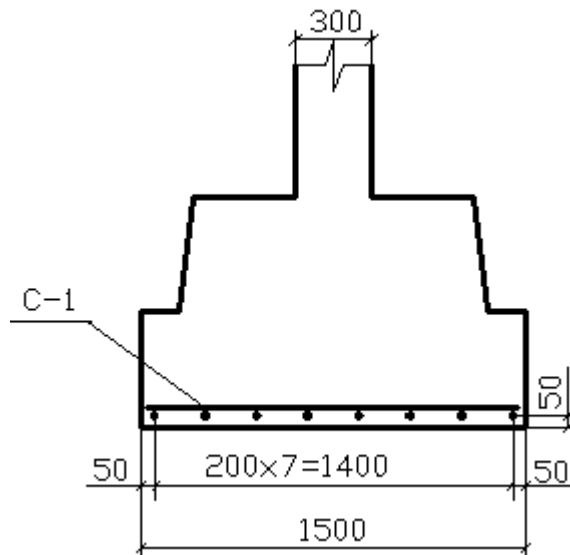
Размещение арматуры фундамента в размере подошвы b_f
